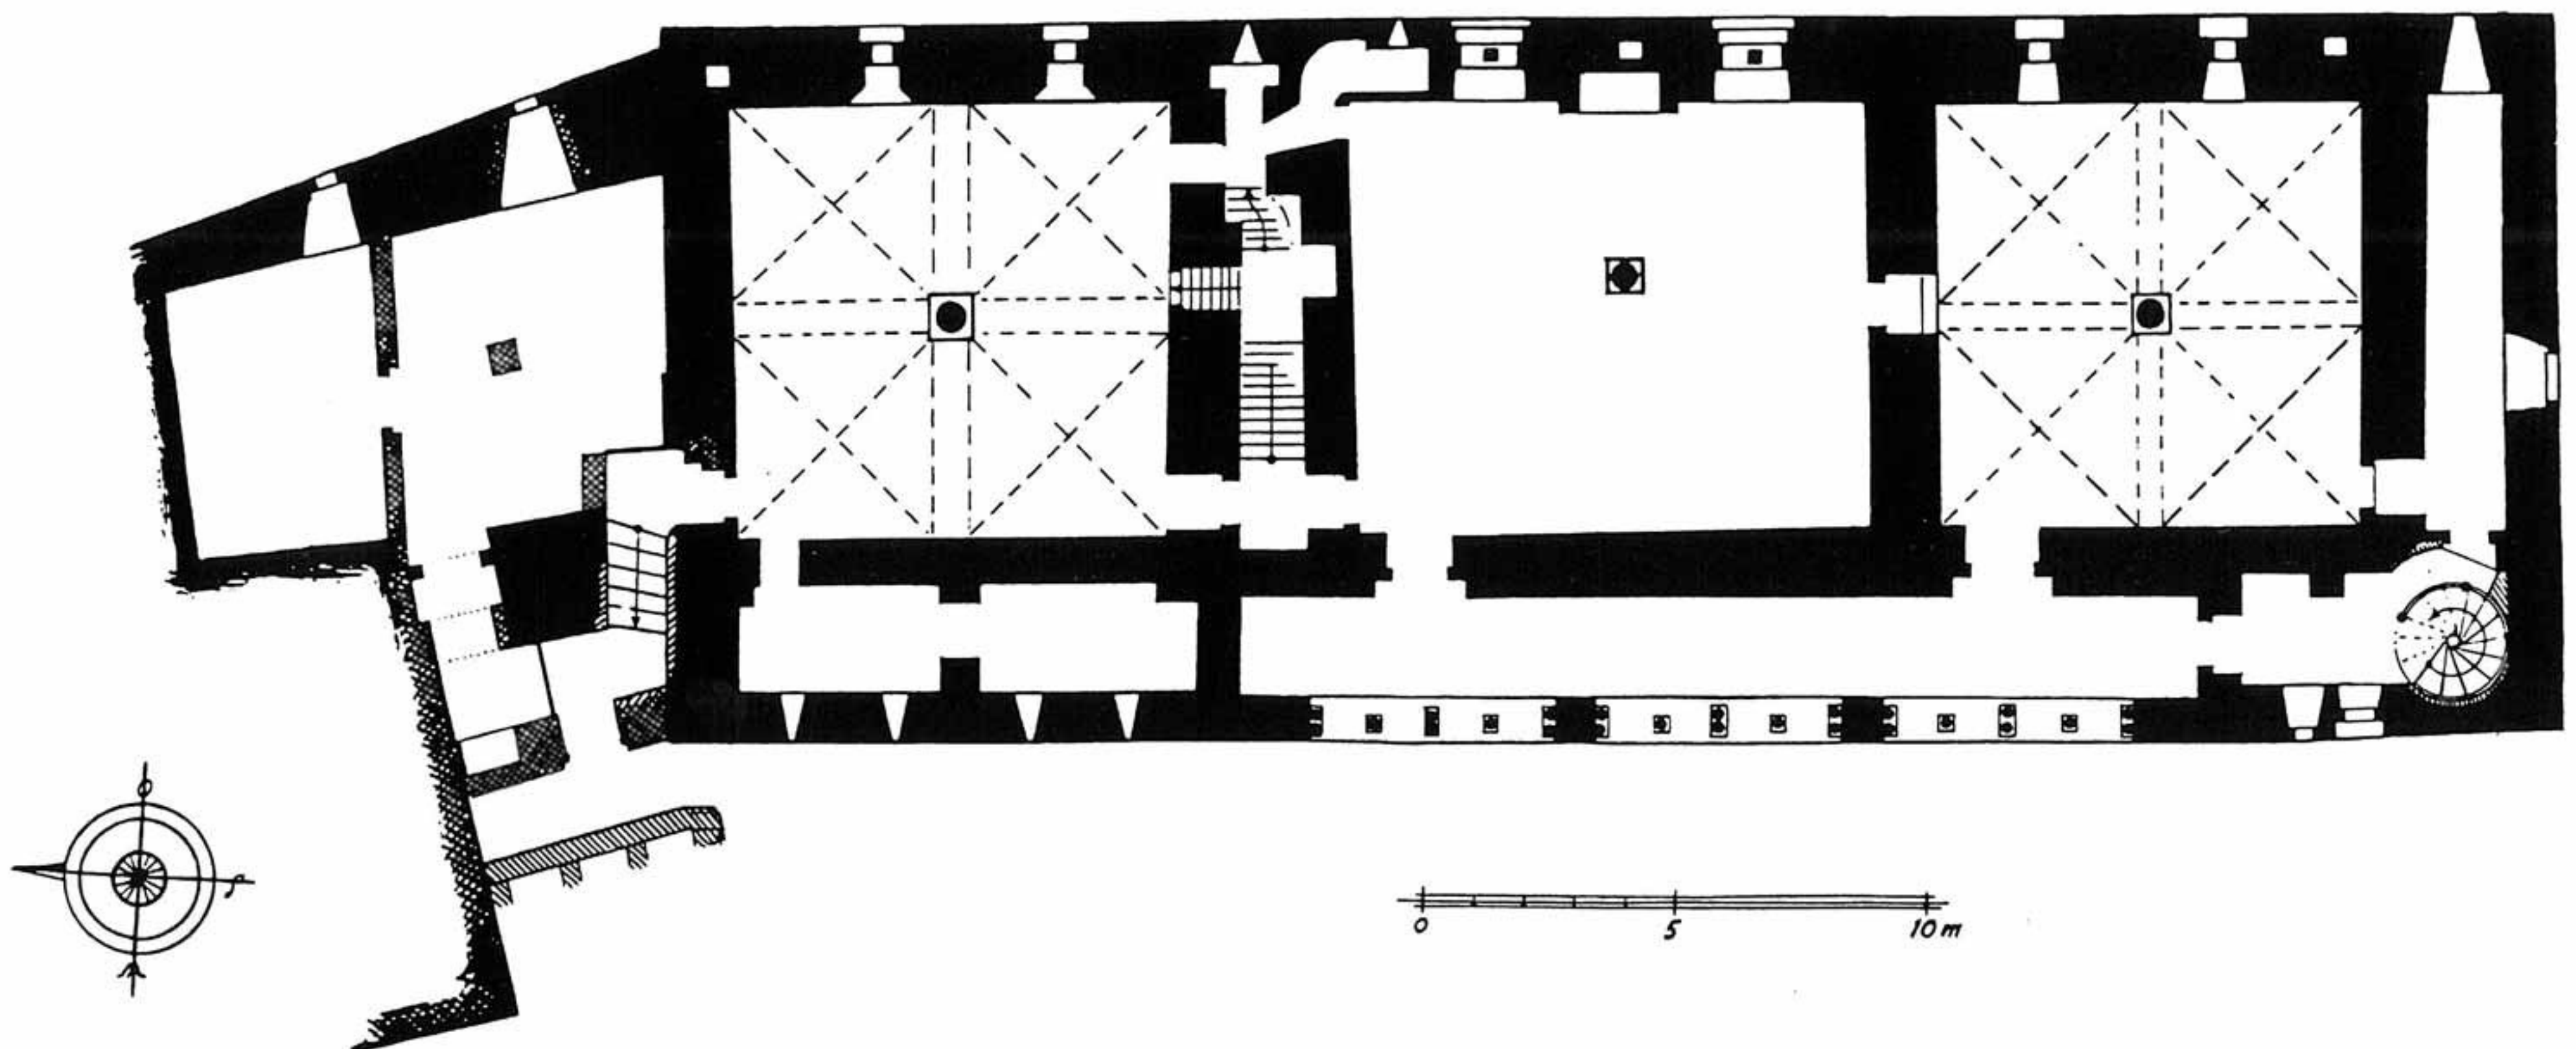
Wartburg. Landgrafenhaus. Grundriß Erdgeschoß.
